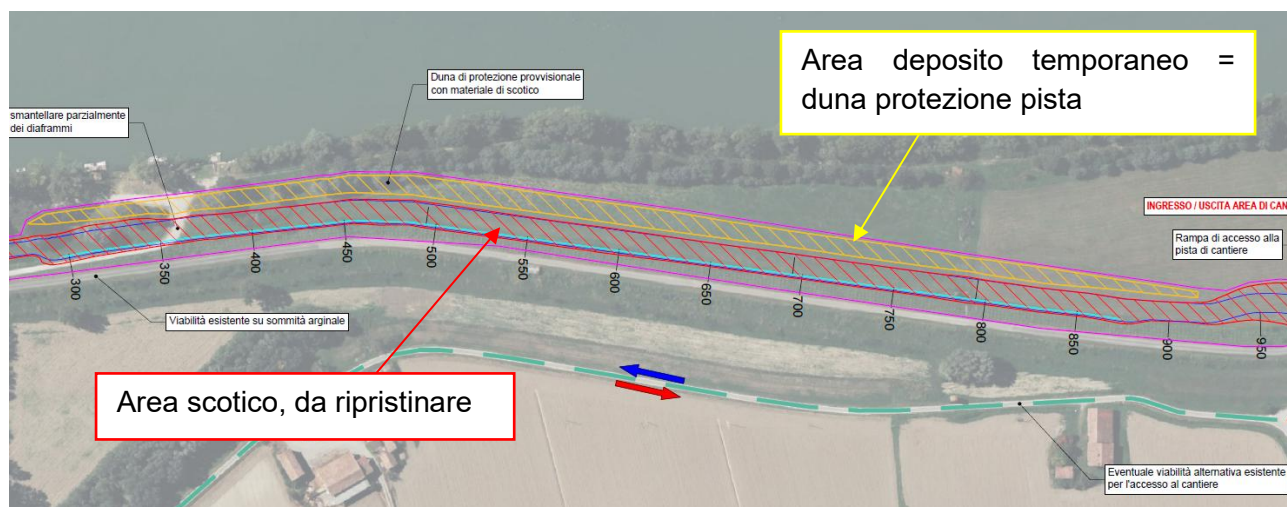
Dettaglio duna area nord Caorso (estratto dalla tavola PE.0.1.6.SIC.GE.P.L.0.0.1 “Layout di cantiere”)
